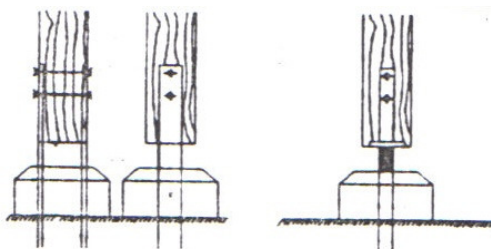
3: Detalhe de pilar com dispositivo metálico de interface com a fundação de concreto
